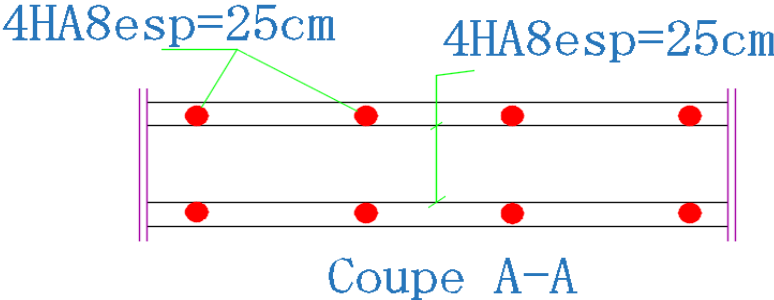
coupe horizontale de ferrailage de l'acrotère.
